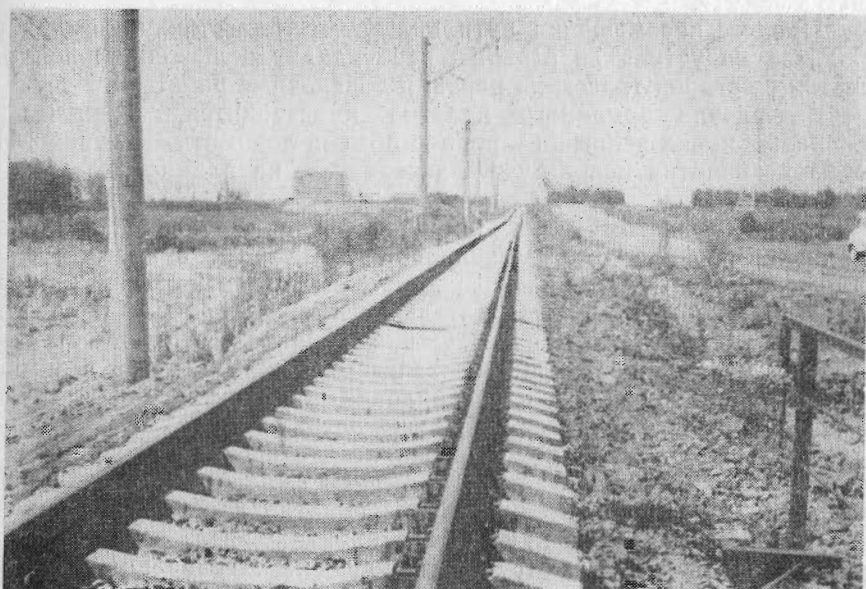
Железнодорожный путь на железобетонных шпалах
